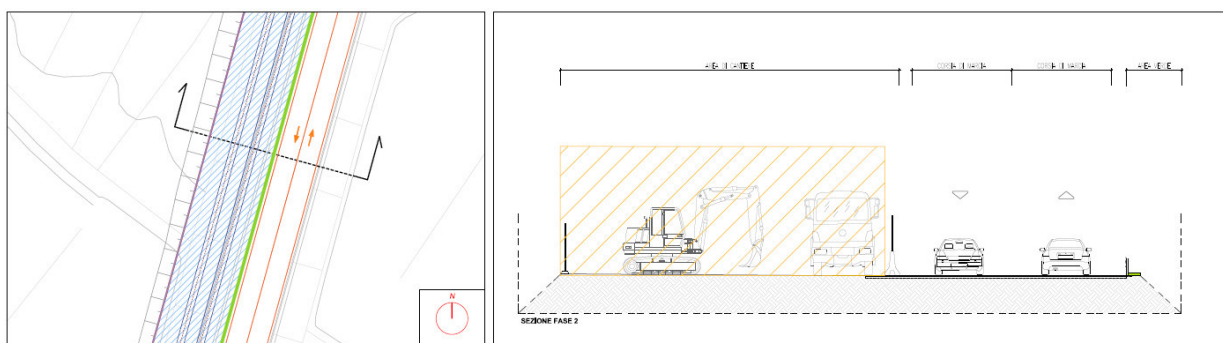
Tipologico cantiere in prossimità di strada Fase 2
